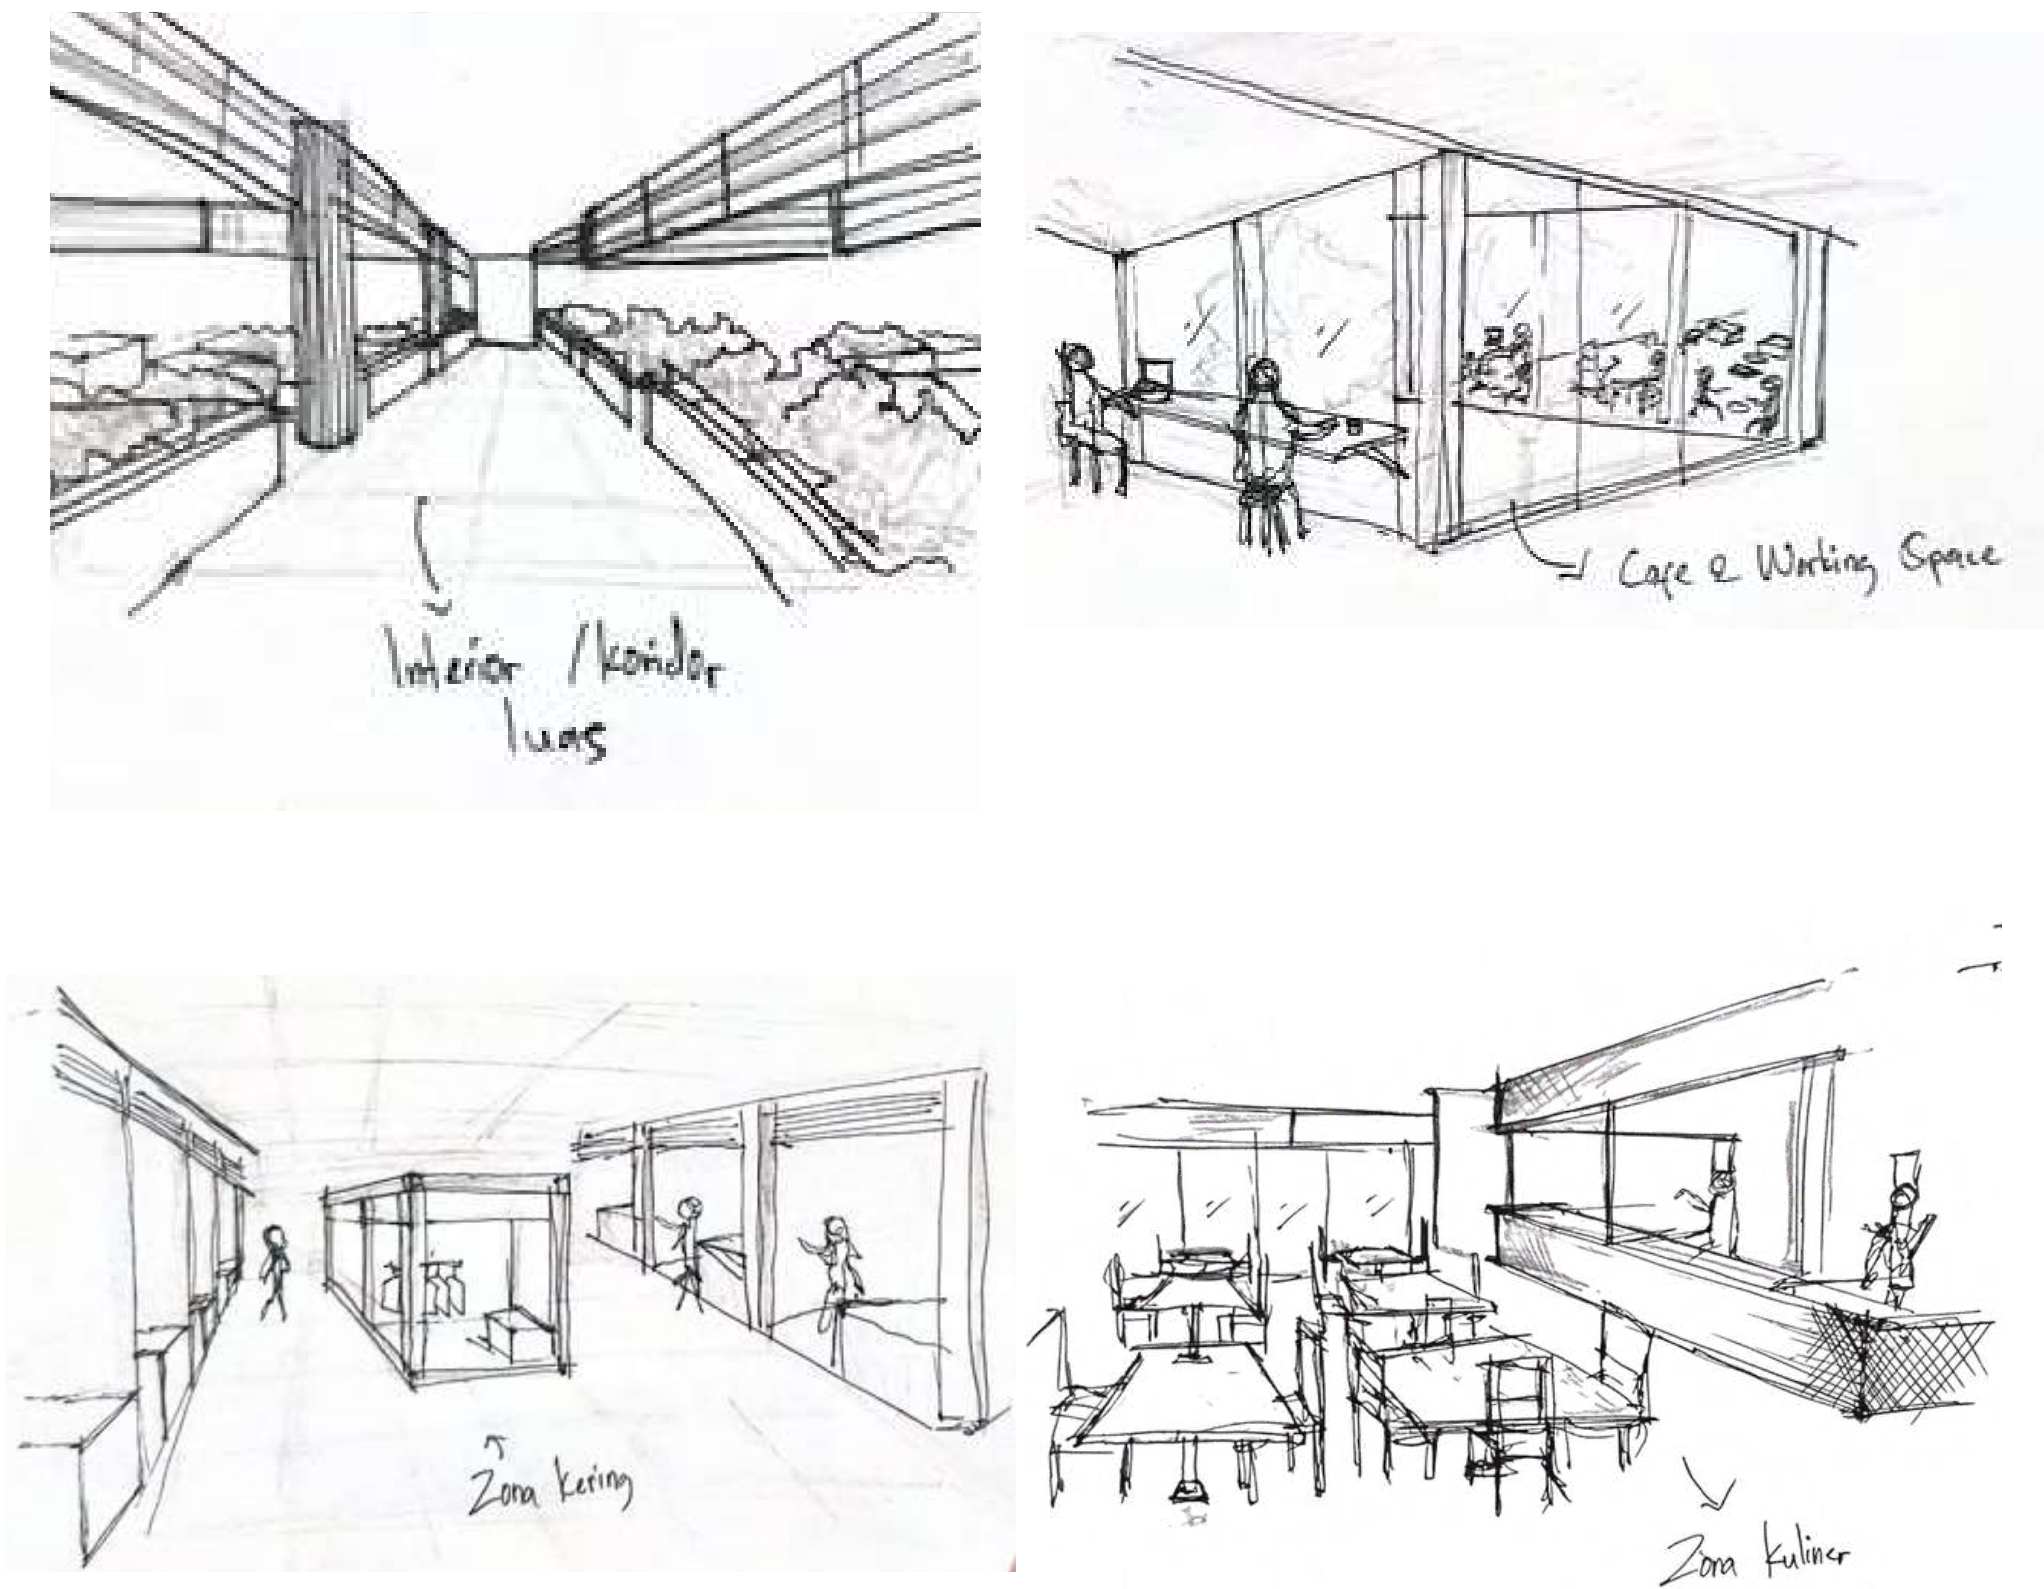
Ilustrasi Rencana Bangunan
